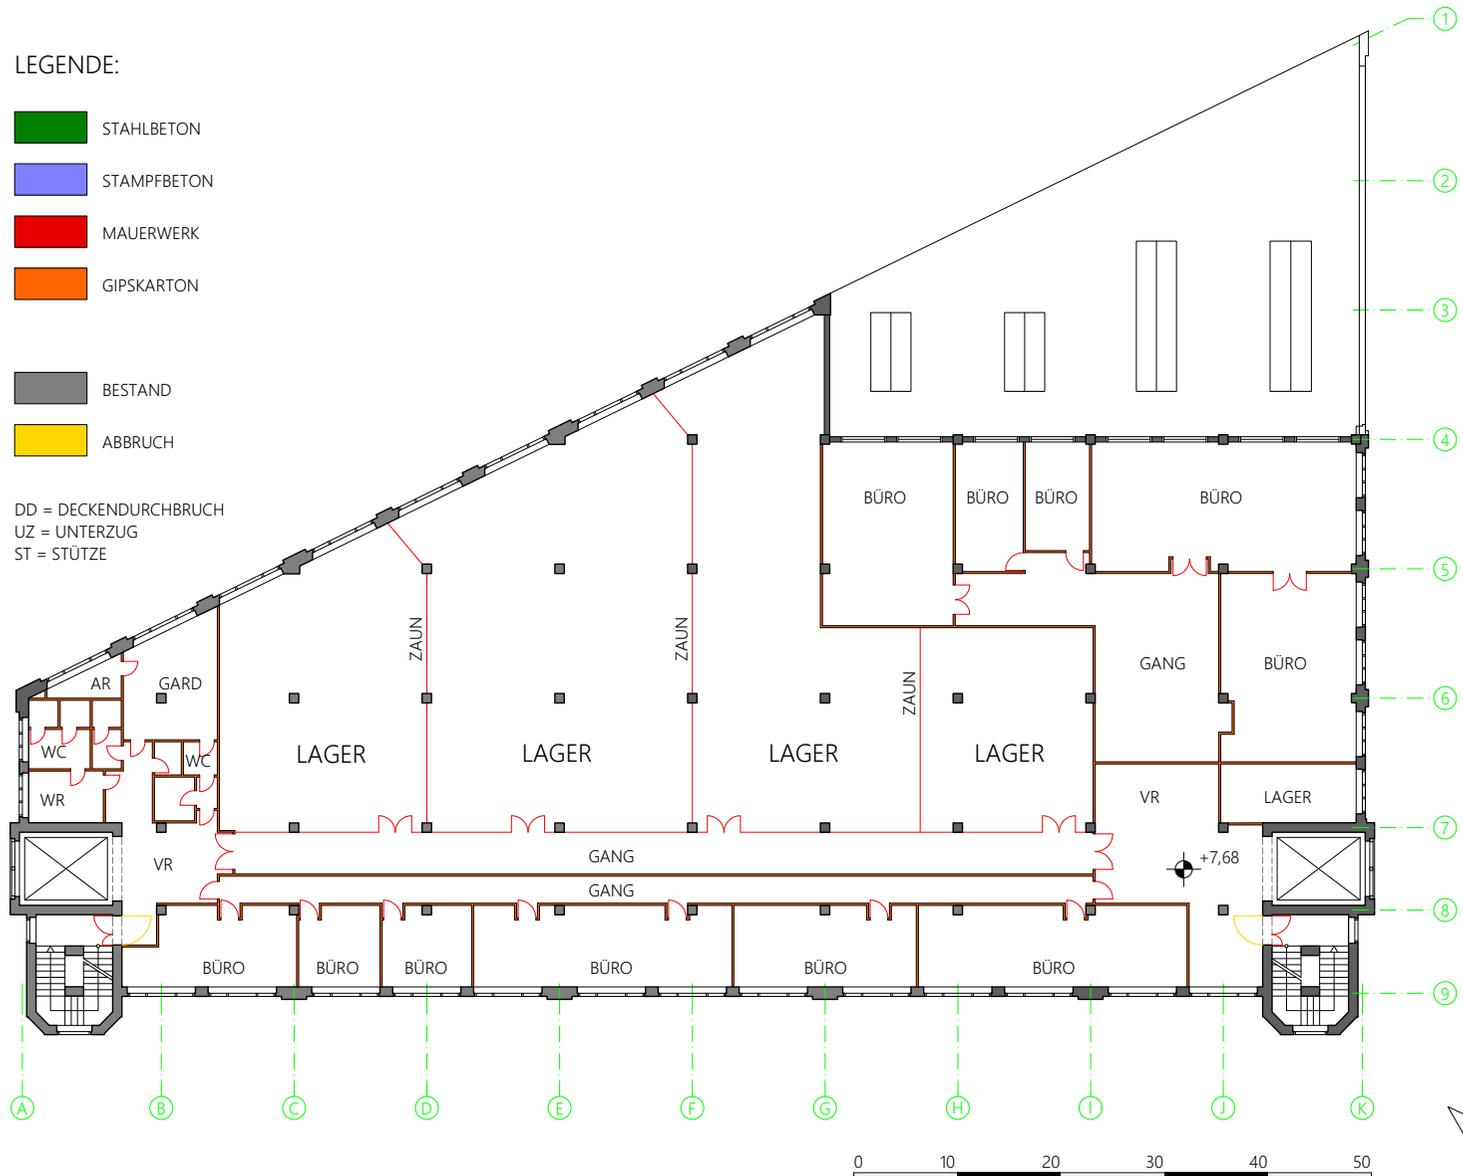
Bauphasenplan 2008: Zweites Obergeschoß des Maschinenmagazins
